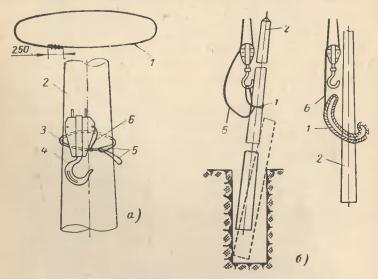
Строповка и расстроповка железобетонных опор. a — строповка опоры; b — расстроповка опоры; b — голожение троса при строповке опоры; b — крюк крана; b — петля троса; b — веревка.
